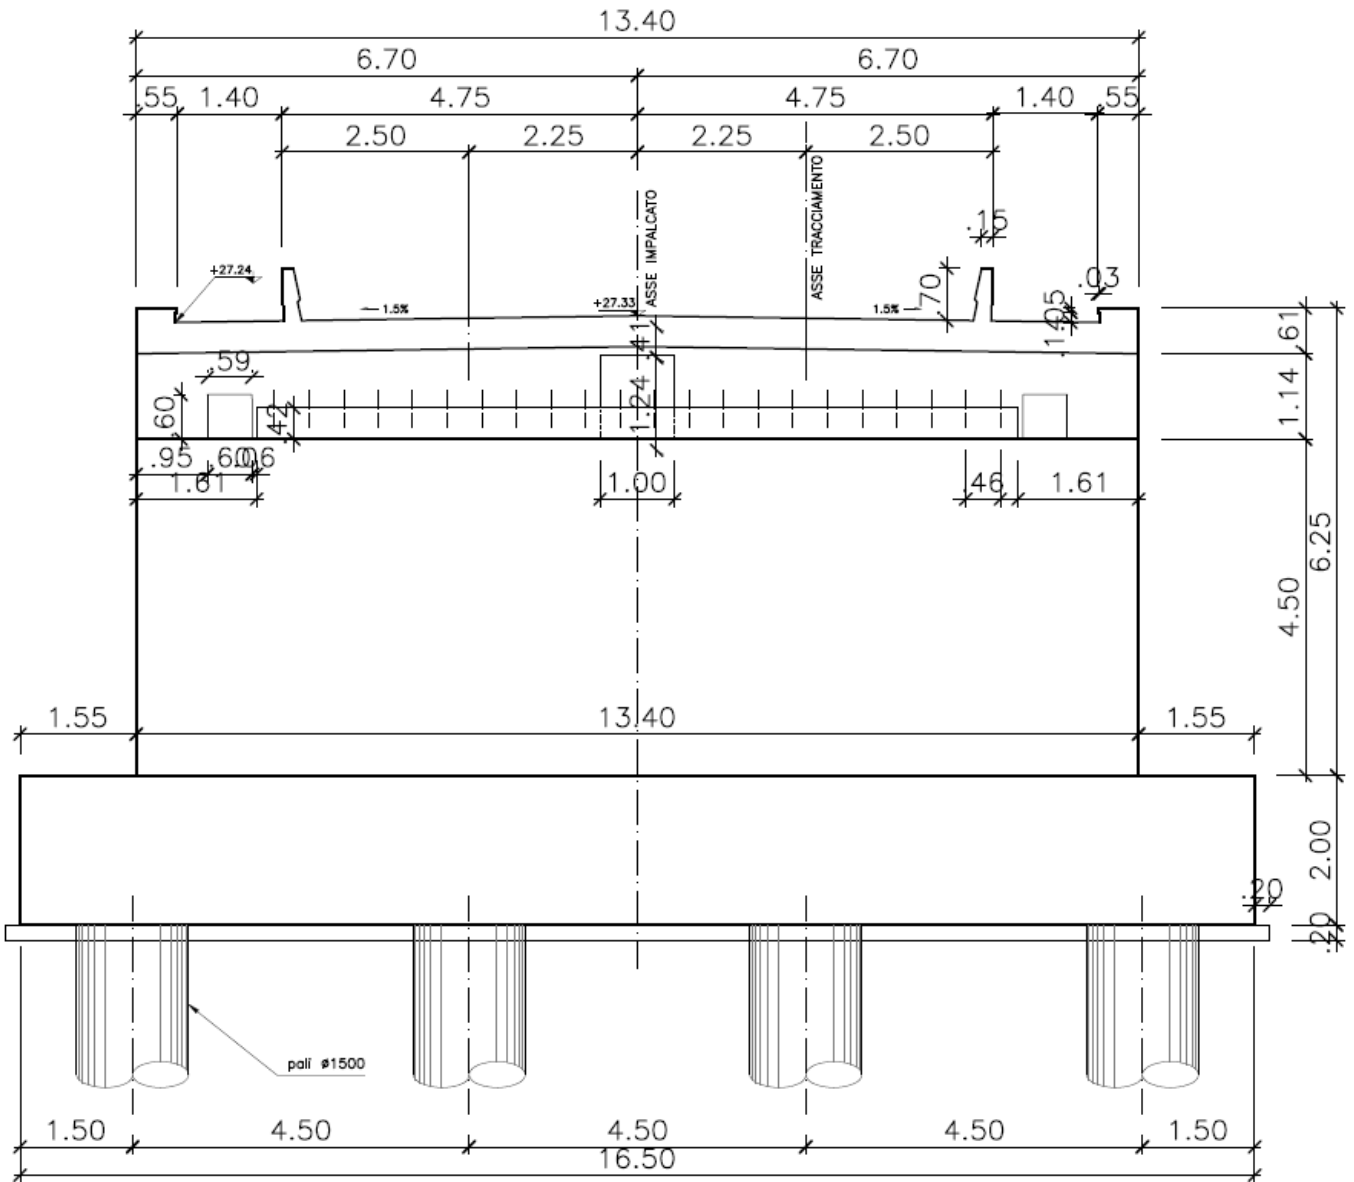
Prospetto frontale Spalla "B".
